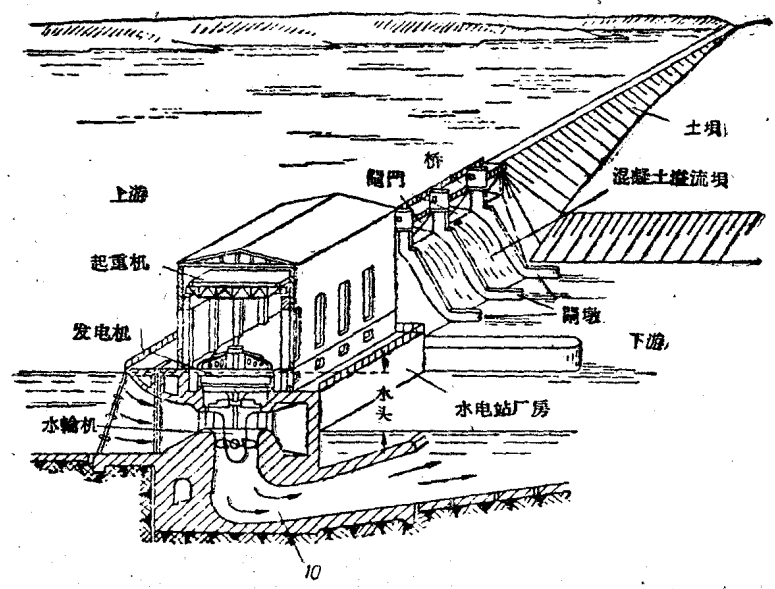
混凝土坝中型河床式水电站建筑物示意图
